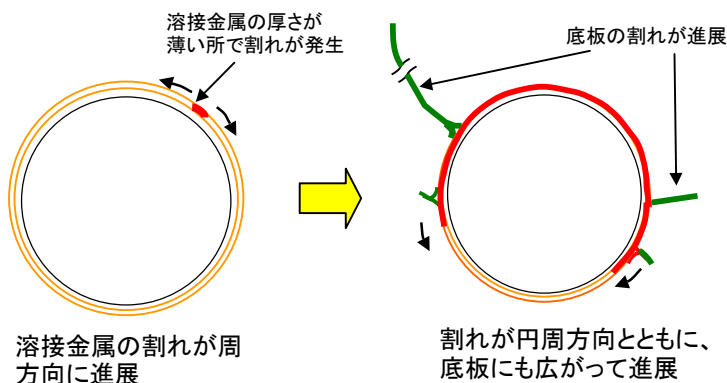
(2) 補助建屋排気筒のひび割れおよびドレン管の接続不良の原因と対策について
